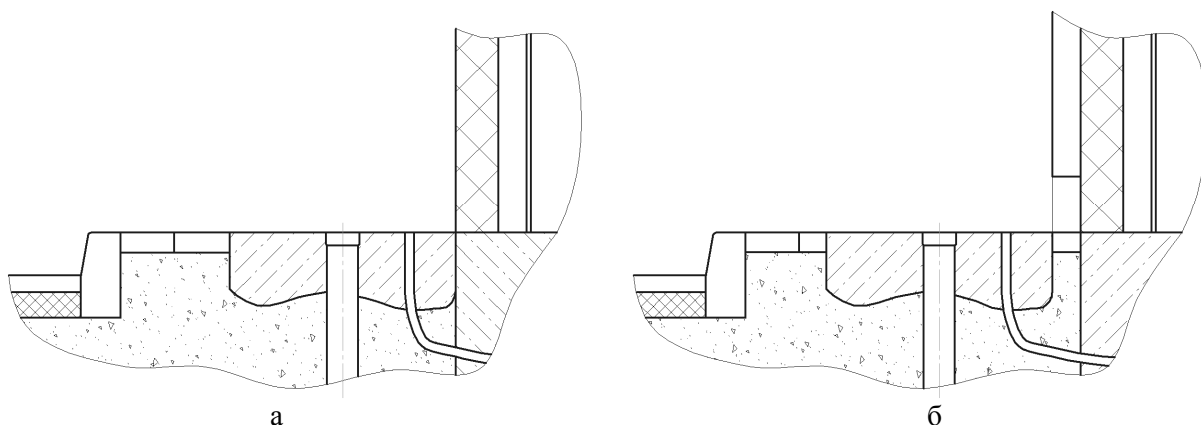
Схемы заливки фундамента при разных облицовках здания АЗС. а - облицовка стены здания АЗС без цоколя;
